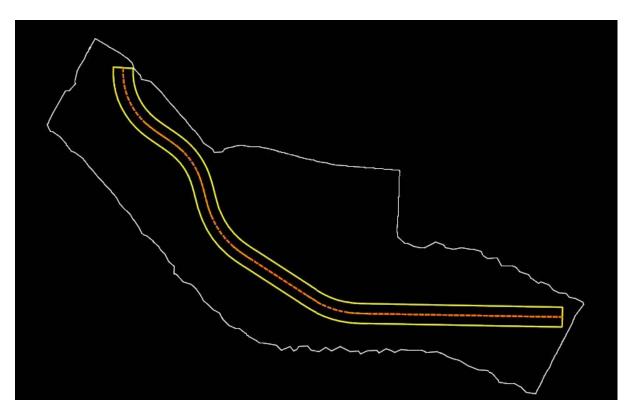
Sopraelevazione del tracciato vista in pianta
